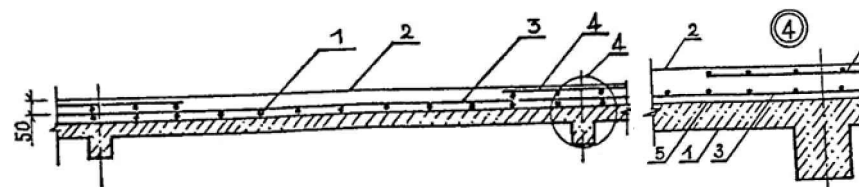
Підсилення плити перекриття нарощуванням зверху при малому зчепленні поверхонь: 1 – плита перекриття, що підсилюється; 2 – монолітний шар бетону; 3 – нижня (прольотна) арматурна сітка; 4 – верхня (напопorna) арматурна сітка; 5 – верхня поверхня плити, яка не має зчеплення з монолітним бетоном (промаслена, забруднена)
